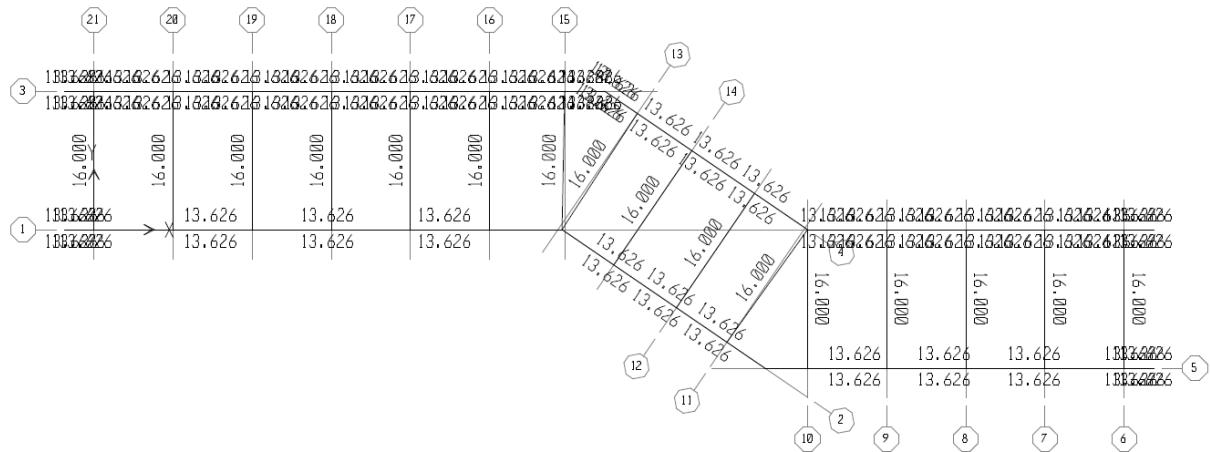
Armimi i trarëve lidhës të pilotave 1 (njësia cm²)
